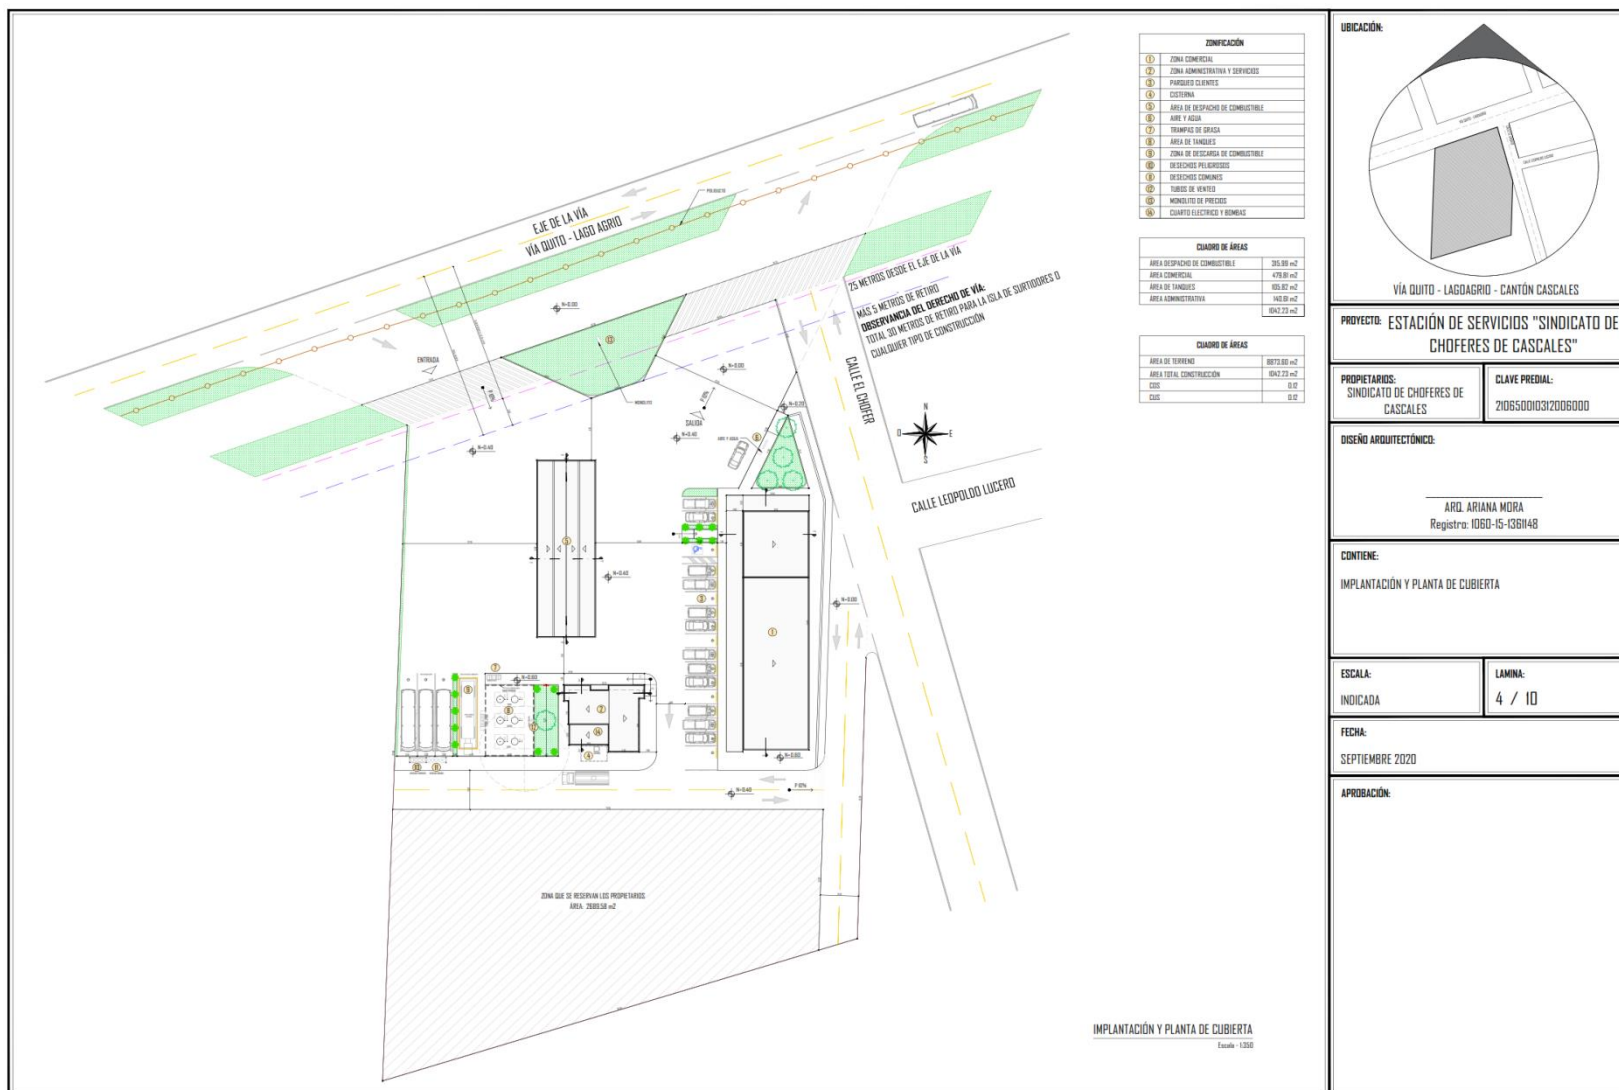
Zonificación – área de desechos # 10 y 11Fuente: Plano arquitectónico
